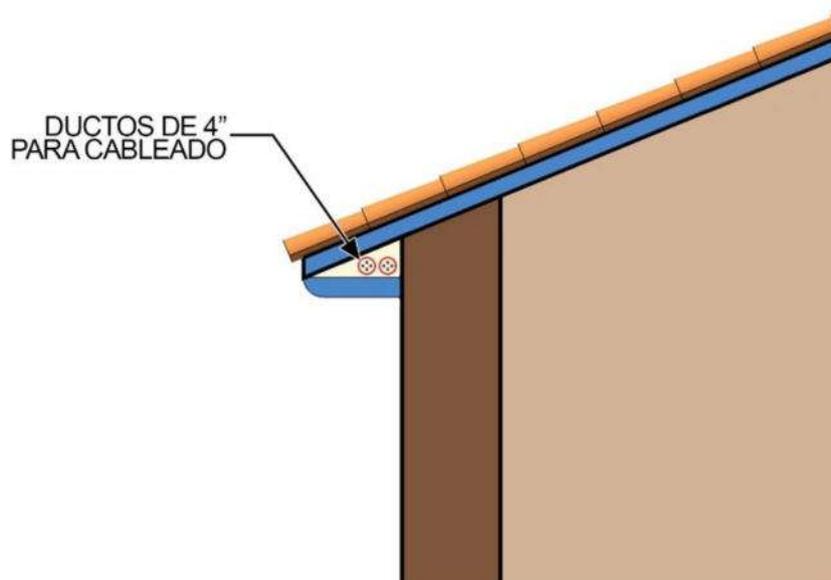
Diseño de aleros con ductos para instalaciones en construcciones nuevas [3]
